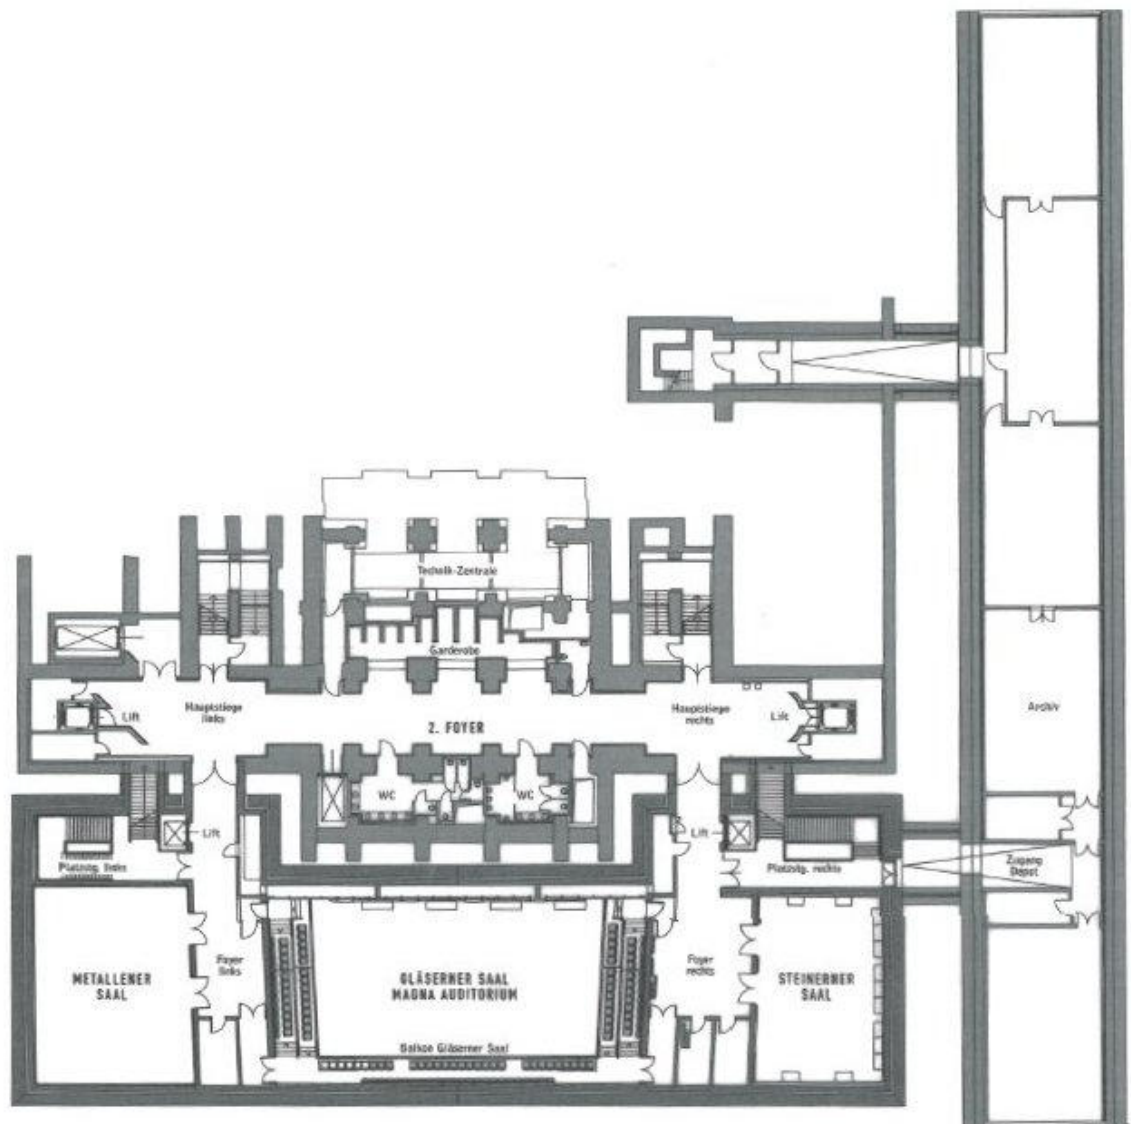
Grundriss 2. Untergeschoß + Depoträumlichkeiten<sup>97</sup>
